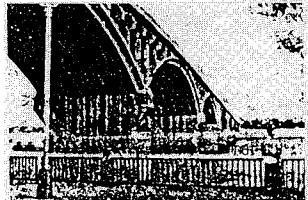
中国の近代的鉄筋コンクリートアーチの湘江大橋
